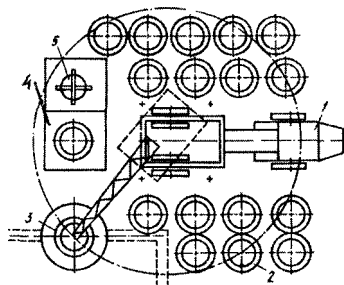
Схема организации работ по монтажу сборной трубы стреловым краном: 1 — монтажный кран; 2 — склад царги; 3 — фундамент трубы; 4 — площадка с кондуктором подготовки царг к монтажу; 5 — площадка для монтажного оборудования
